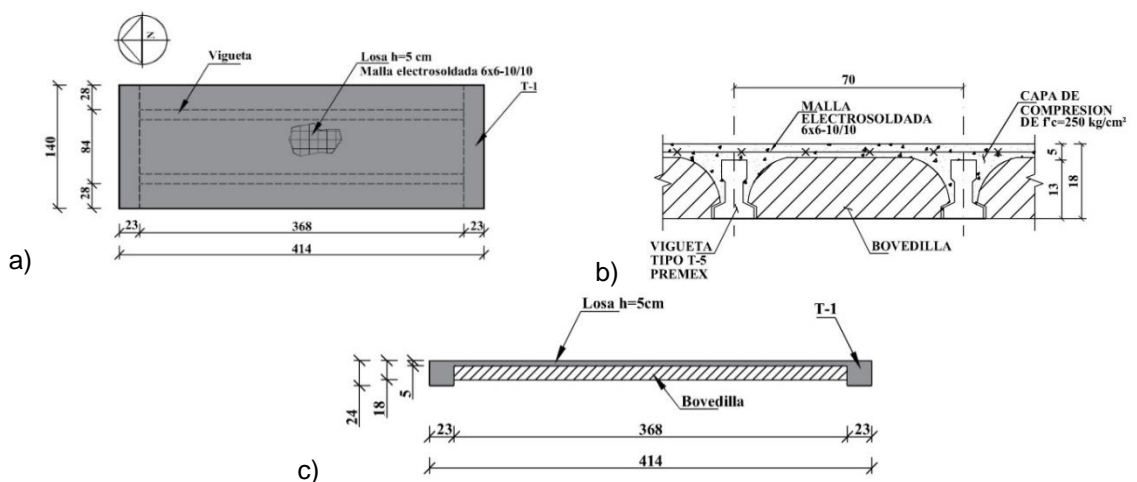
Dimensiones y características físicas de la losa de prueba con vista: a) planta y b) transversal y c) lateral
